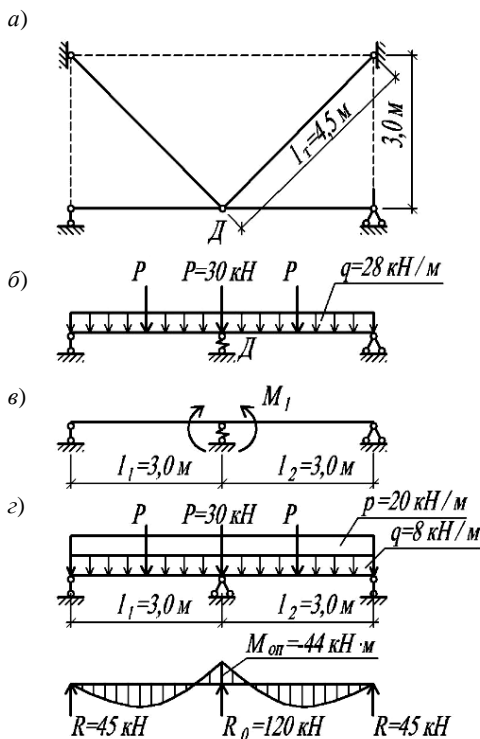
Схемы к расчёту усиления балки тяжами
